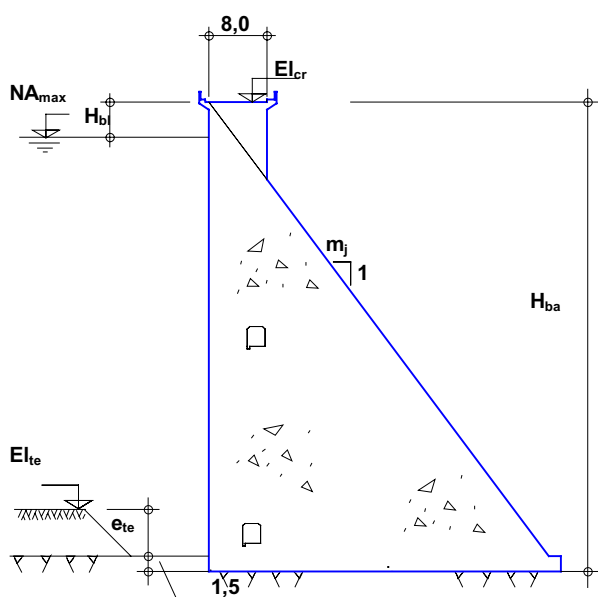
Seção típica de barragem de concreto convencional a gravidade.
